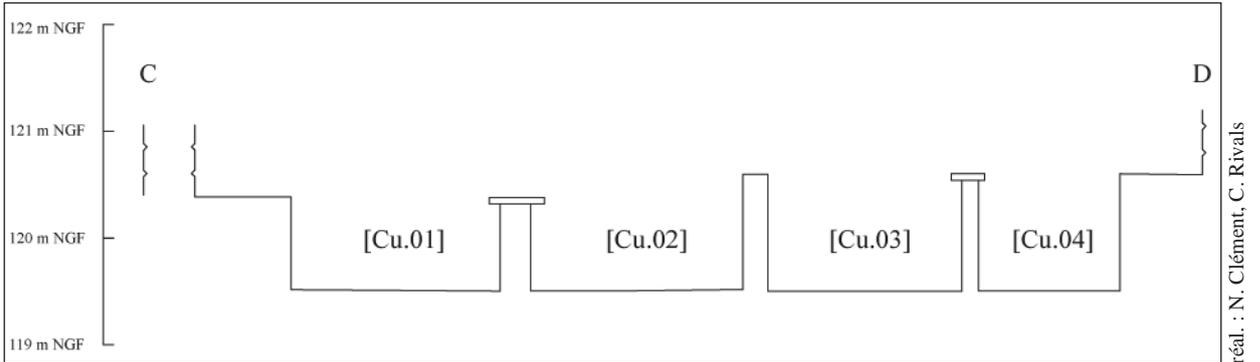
coupe [CD] (nord / sud) du rez-de-chaussée
